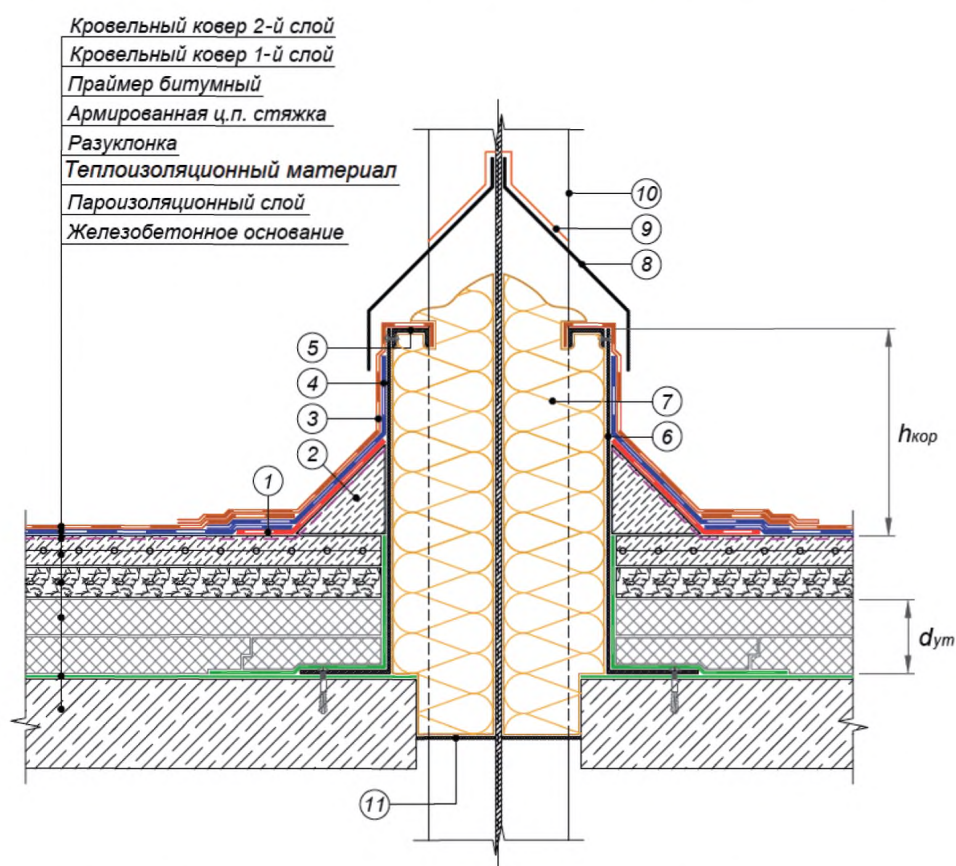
Схема прохождения колонны через совмещенное кровельное покрытие. Вариант 1
